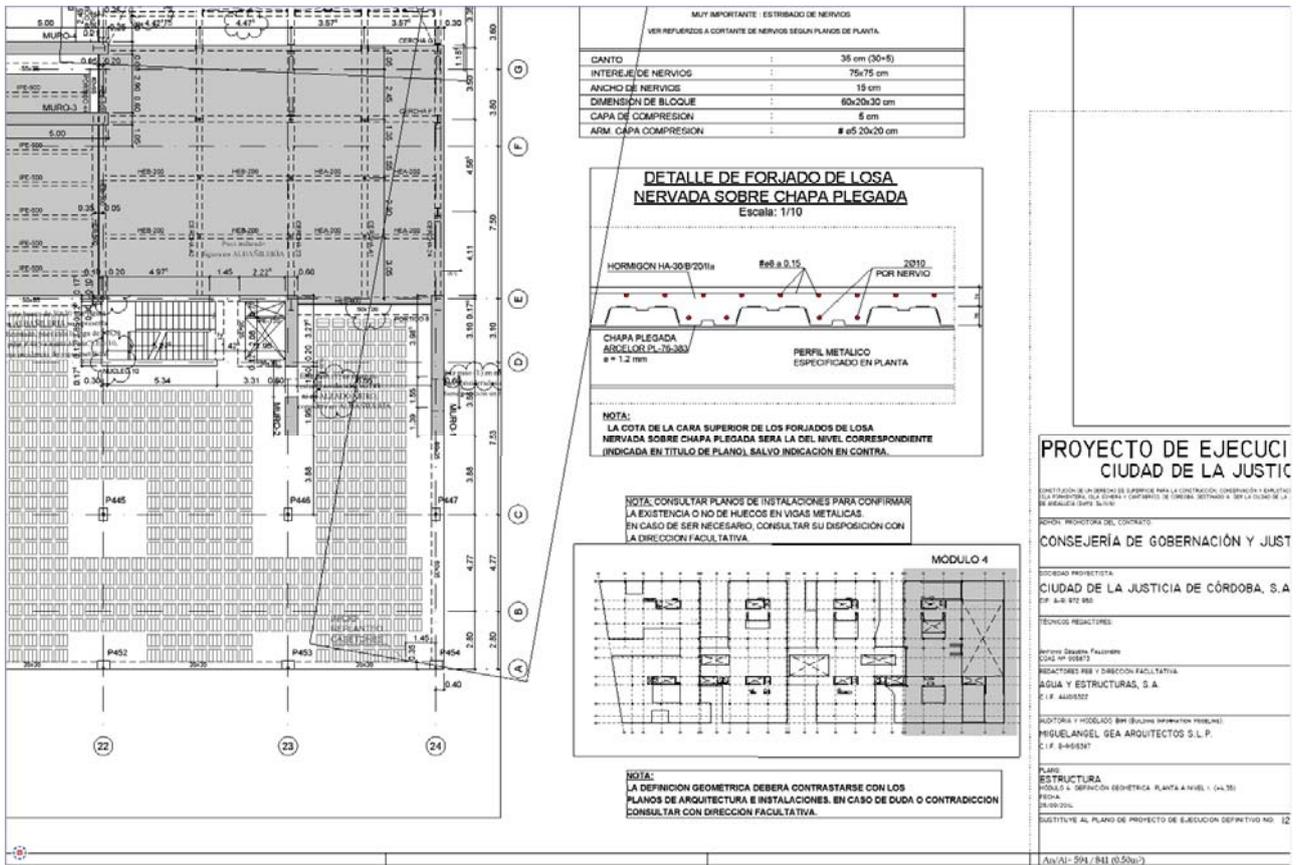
Detalle del plano de definición geométrica de la estructura (planta primera, módulo M4).
